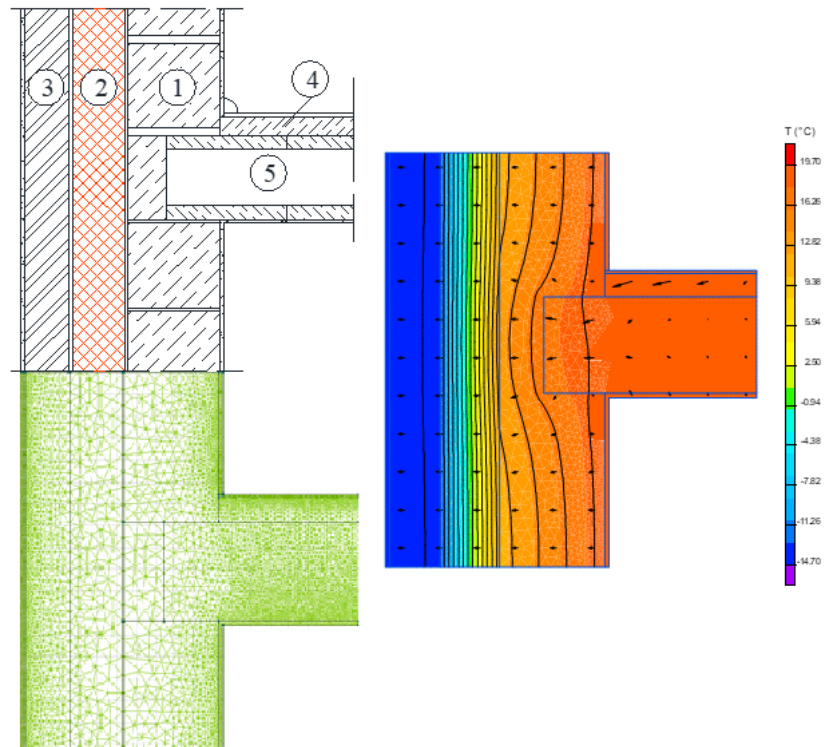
Распределение температурных полей в ограждающих конструкциях междуэтажного перекрытия без гибких связей.
